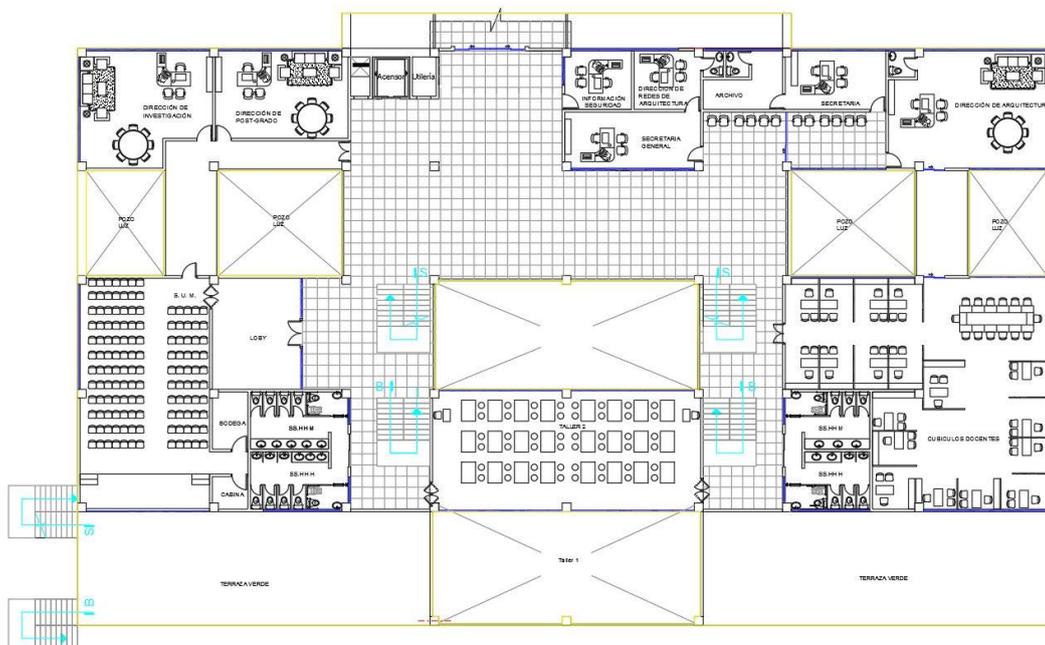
Planta baja arquitectónica nivel N+8.00 m
